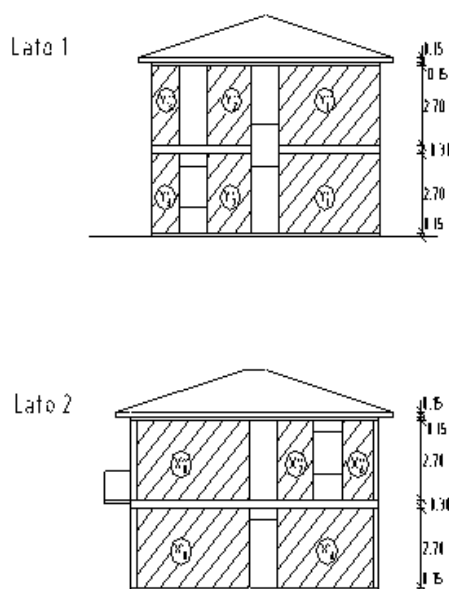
Prospetti con indicazione degli elementi resistenti
